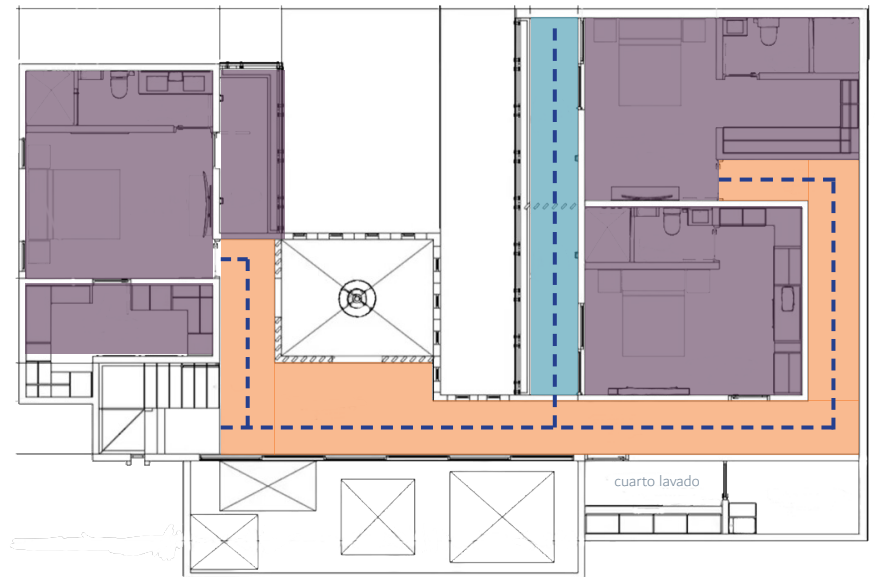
Casa Roble 23. Planta primera. (Fuente: Gimetric Arquitectos)
